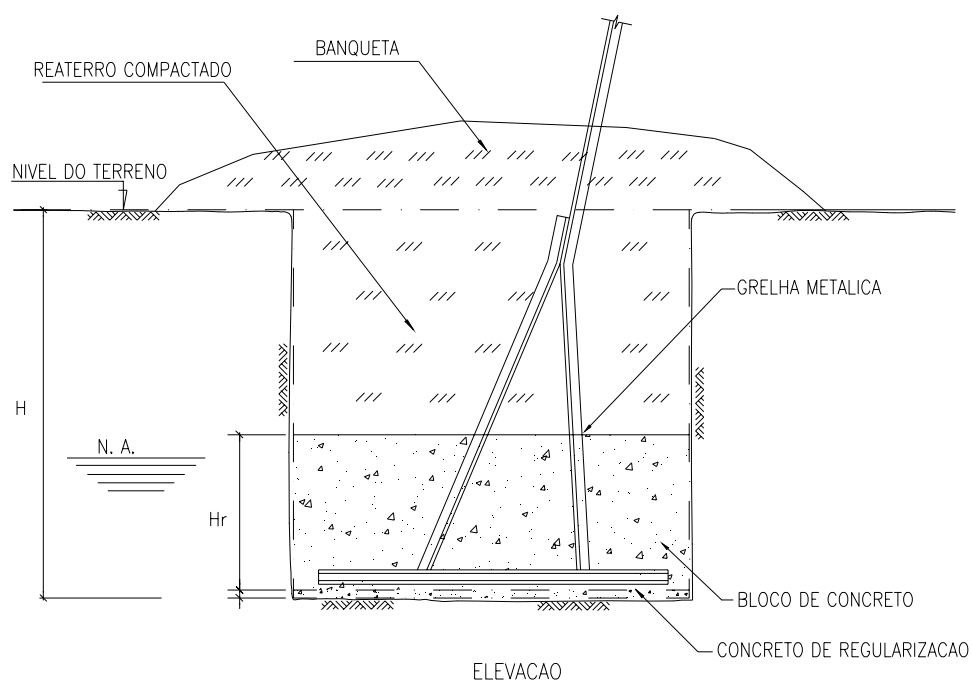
Grelha Metálica com Bloco de Concreto (GBC)
